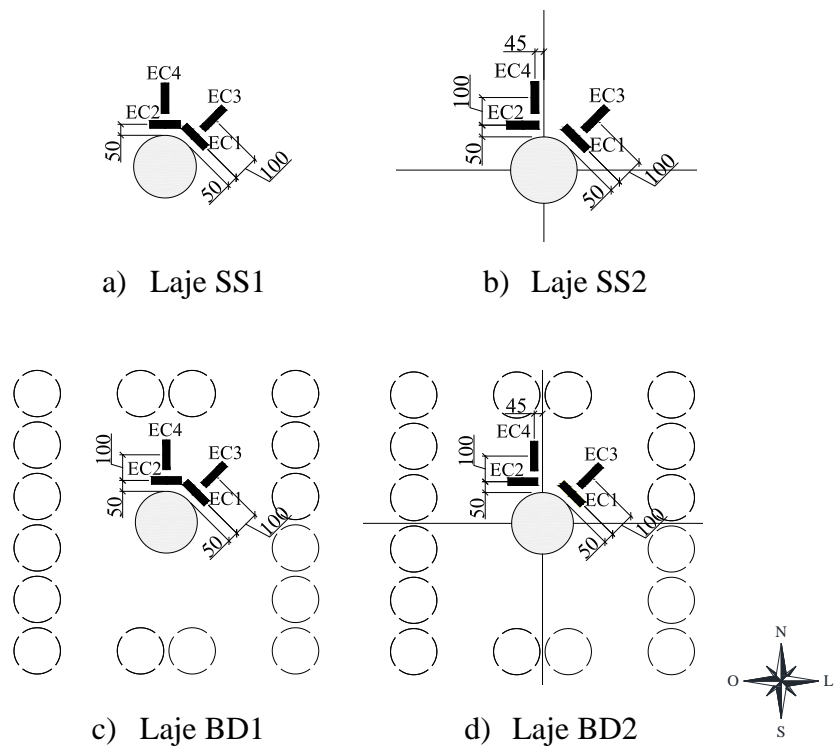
Instrumentação do concreto das lajes (cotas em mm)
